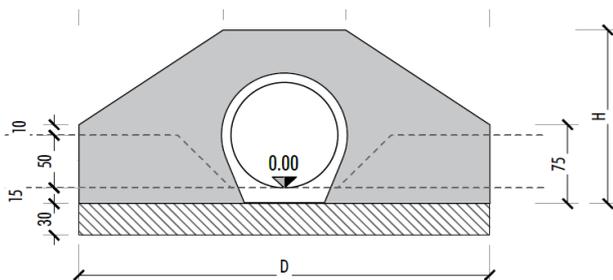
MANUFATTO D'IMBOCCO/SBOCCO TIPO 2
